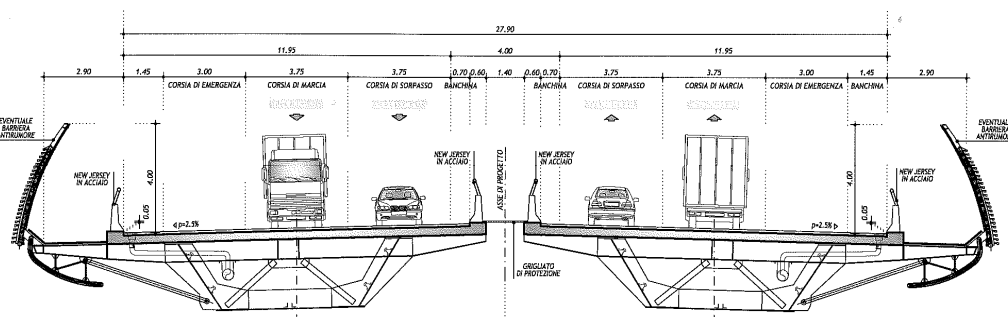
SEZIONE TIPO SU VIADOTTO
